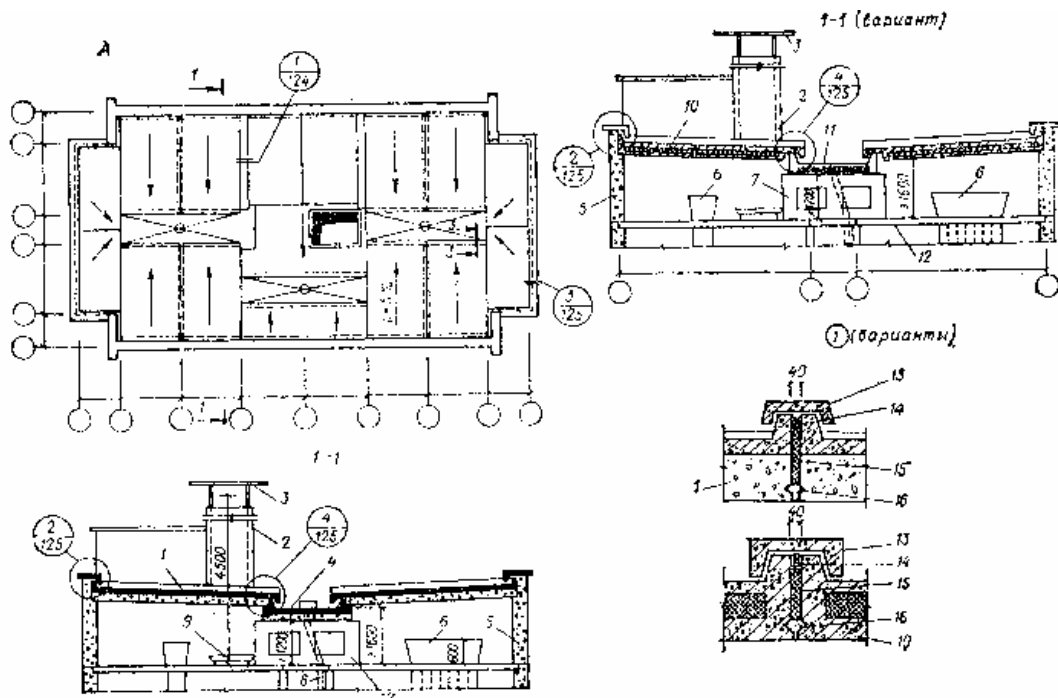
Безрулонные крыши с теплым чердаком (тип Г), А – схема-план, крыши; 1 – двухслойная теплая безрулонная кровельная панель; 2 – вытяжная шахта; 3 – защитный зонт; 4 – двухслойная лотковая панель; 5 – фризровая панель; 6 – оголовок вентиляционной шахты; 7 – опорный элемент лотковой панели; 8 – стояк внутреннего водостока; 9 – водосборный лоток; 10 – трехслойная кровельная панель; 11 – тоже, панель лотка; 12 – панель чердачного перекрытия; 13 – бетонный нагельник; 14 – герметизирующая мастика; 15 – утеплитель; 16 – бетонная шпонка
